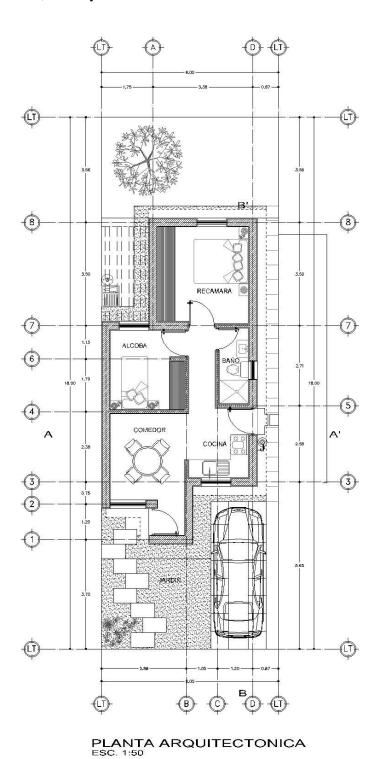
Propuesta de planta arquitectónica-casa de interés social. Fuente: Elaboración Propia.
